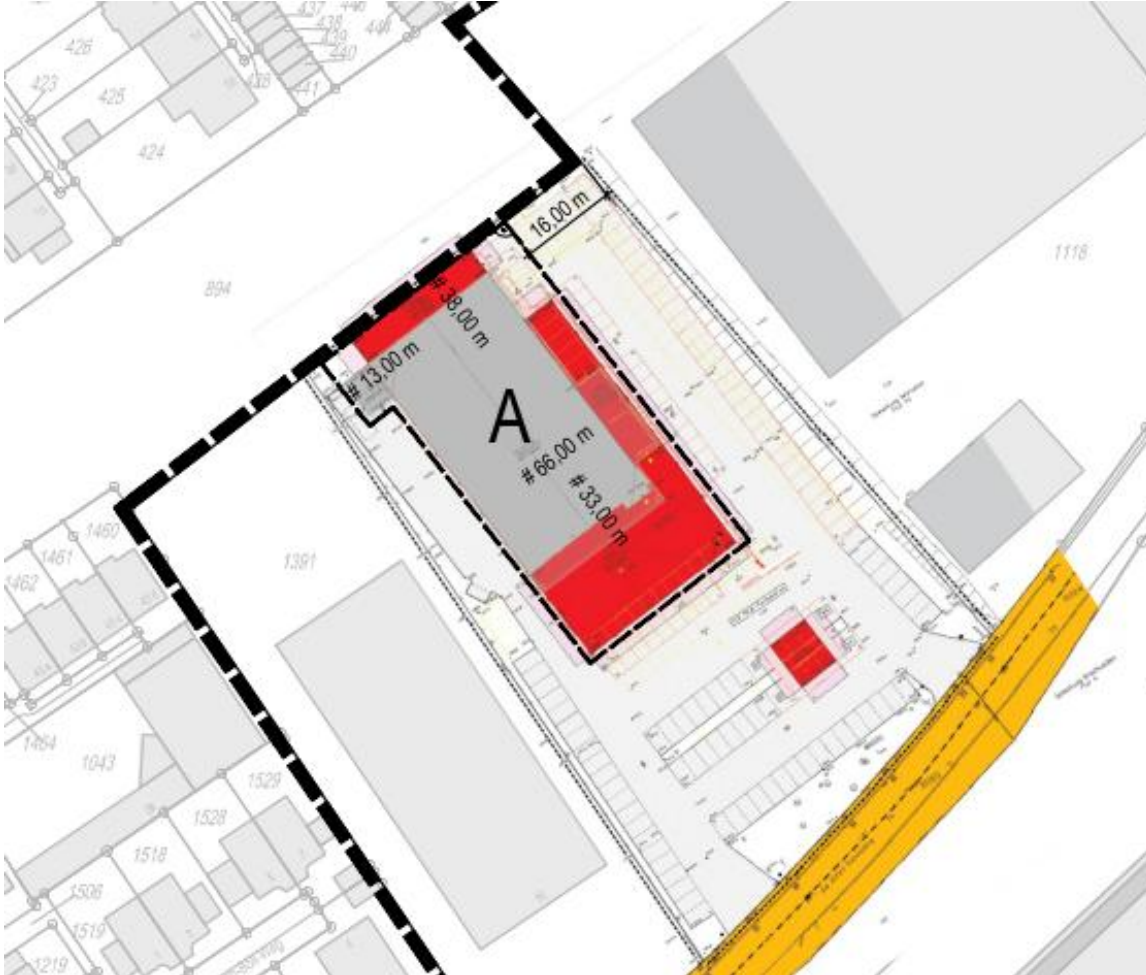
Festlegung der Teilfläche A auf der Grundlage des Bauantrages
